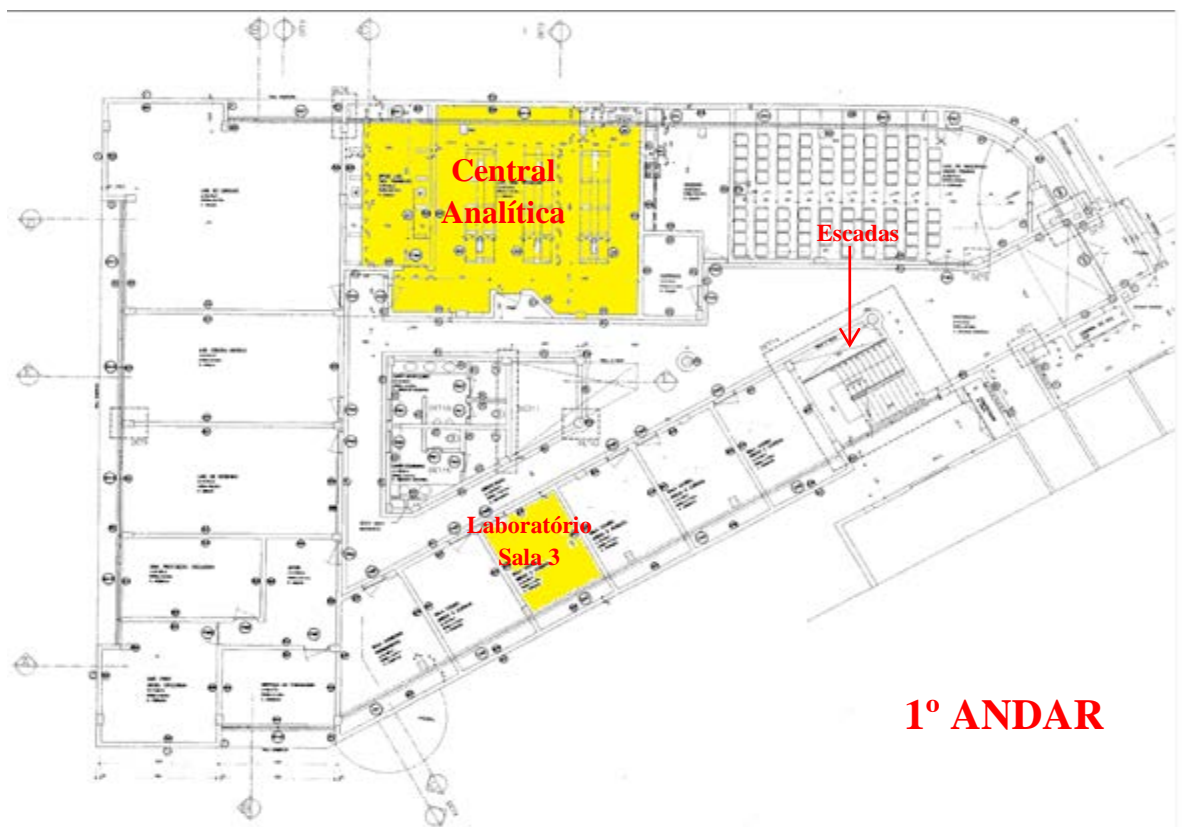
Planta baixa do 1º andar (central analítica e laboratório).
